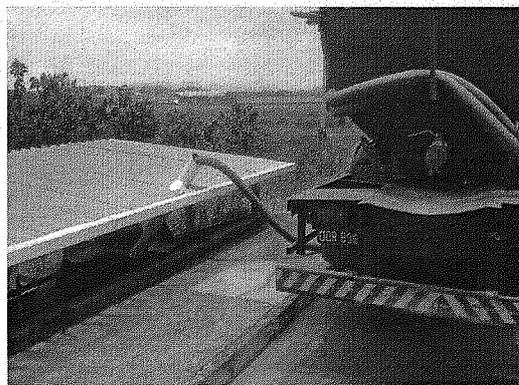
Remoção de efluente na caixa de acúmulo do canteiro da Enfil.
